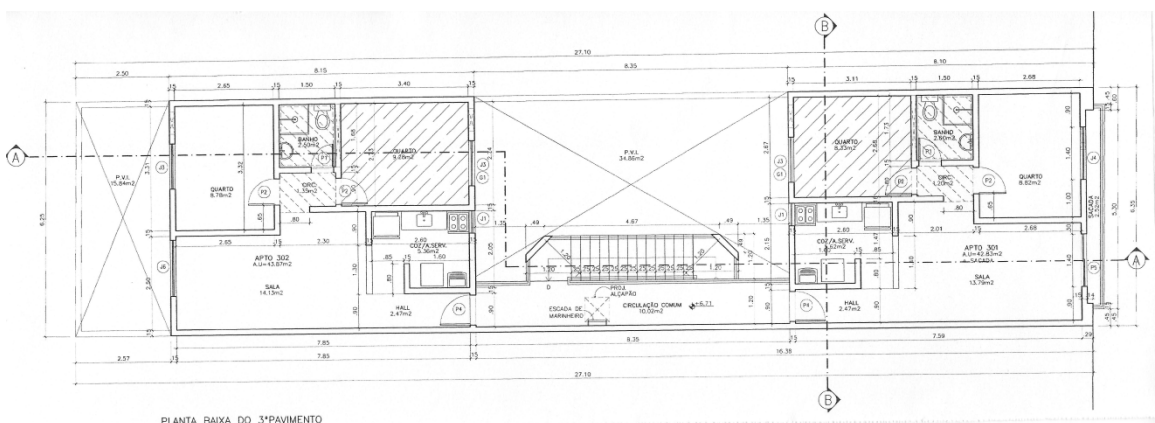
Planta baixa do 3º pavimento do empreendimento João Álvares 16.
